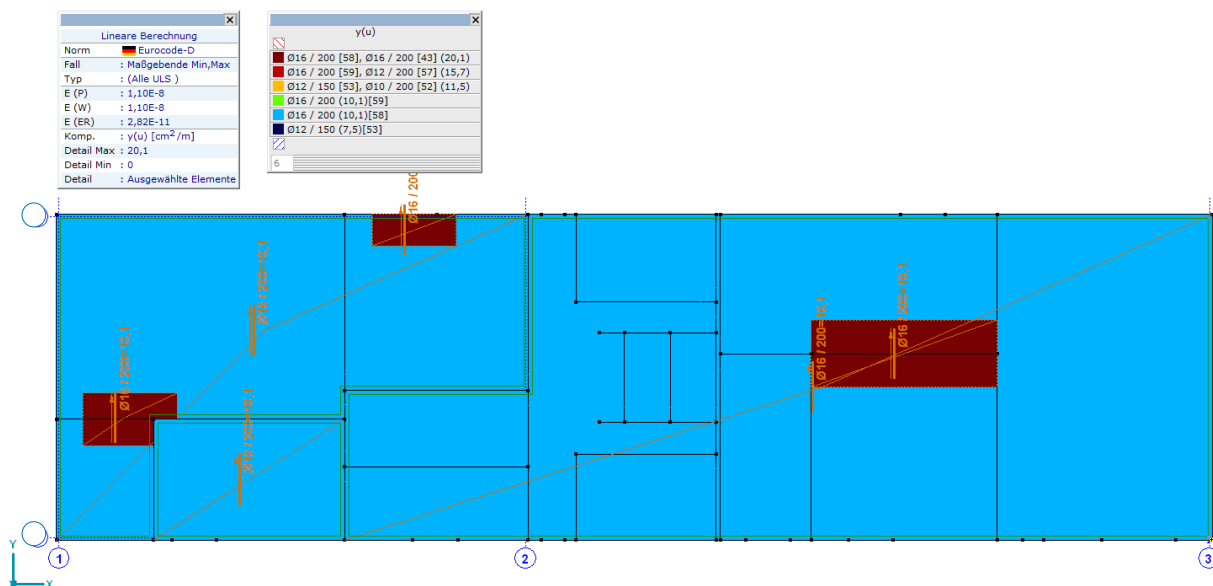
Entworfenere untere Bewehrung in lokaler y-Richtung
